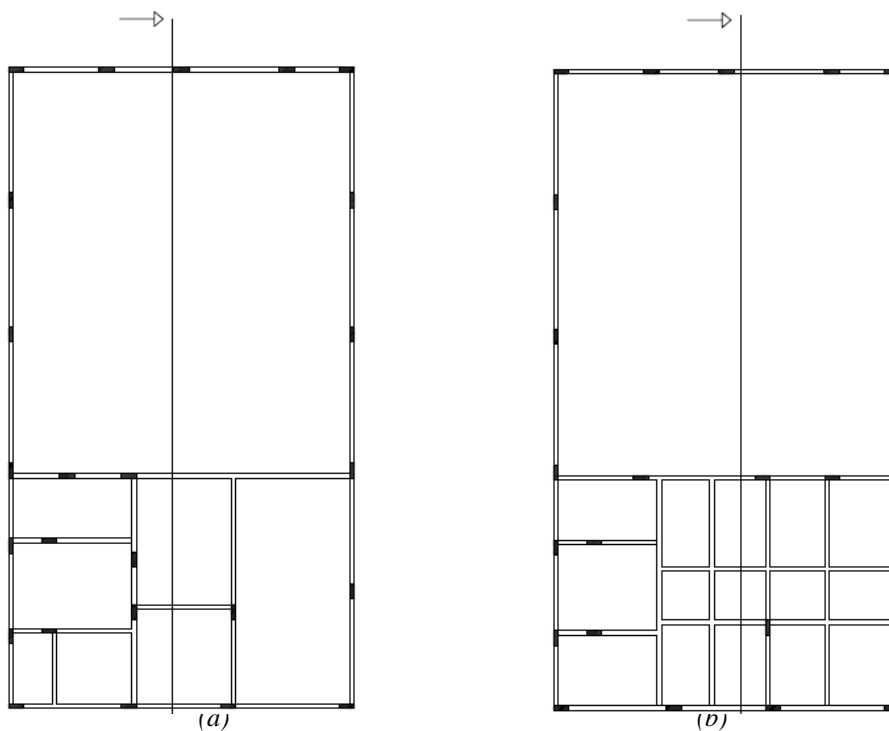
Esboço da estrutura do anexo A (a) 1º pavimento (b) 2º pavimento
